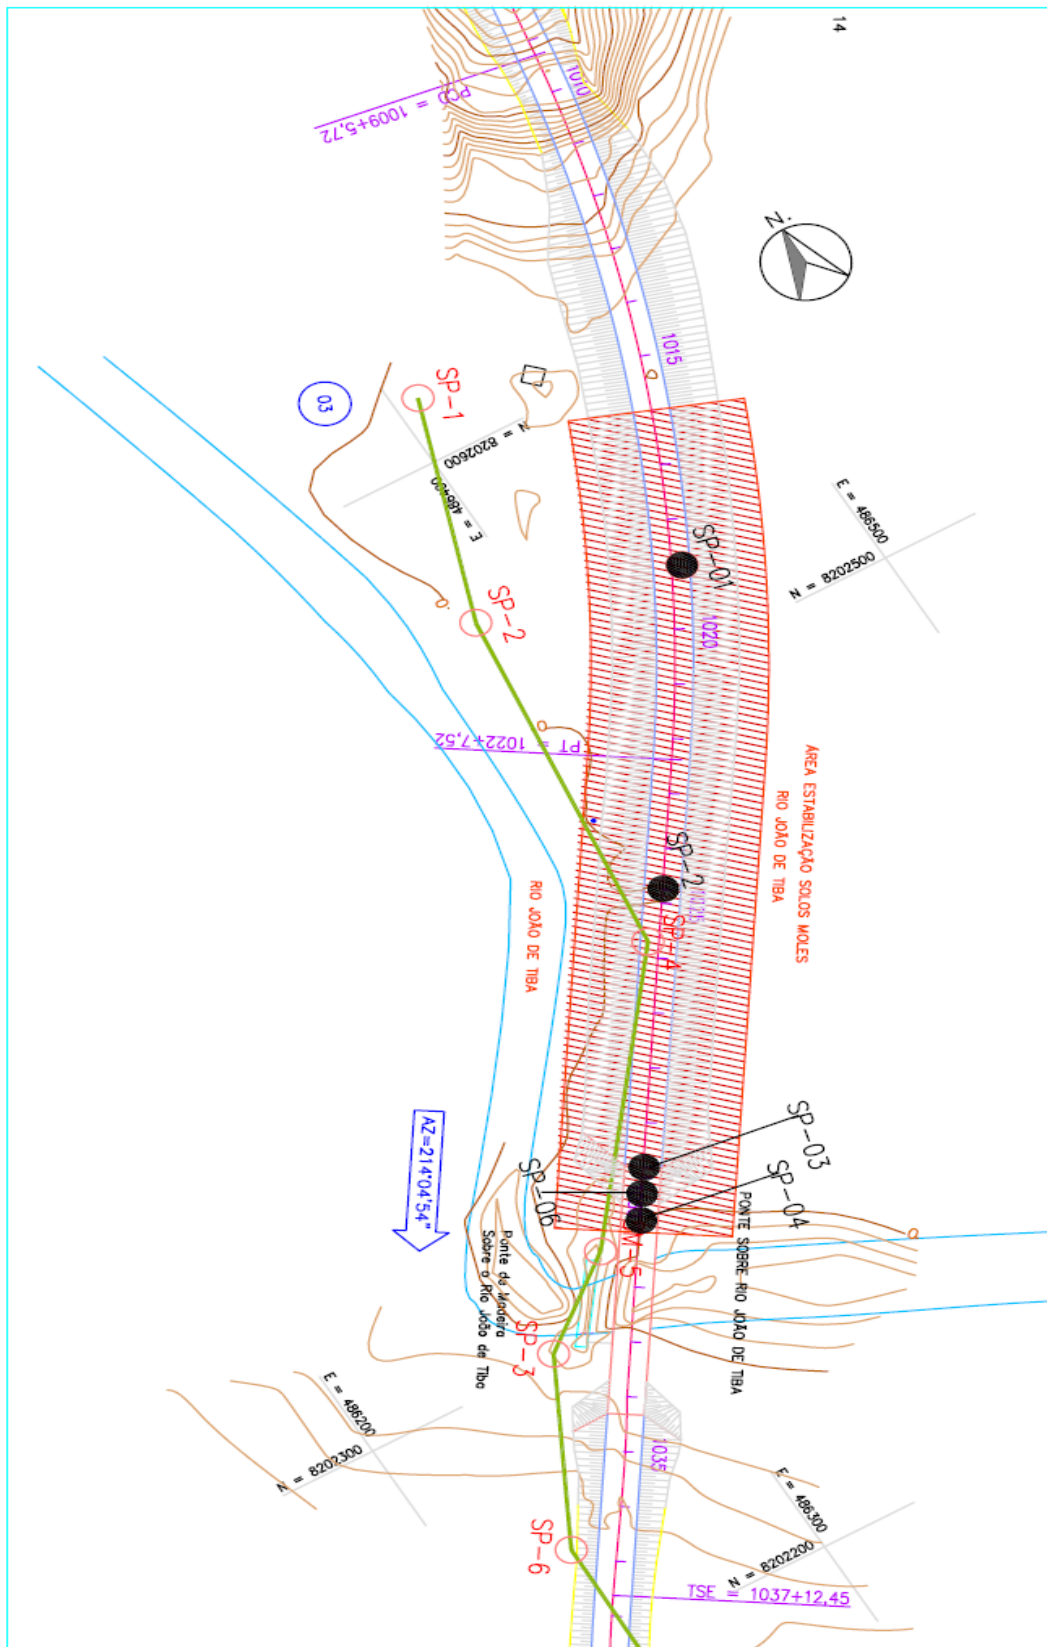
Planta da área de estabilização do rio João de Tiba (CAMPOS, 2004).
